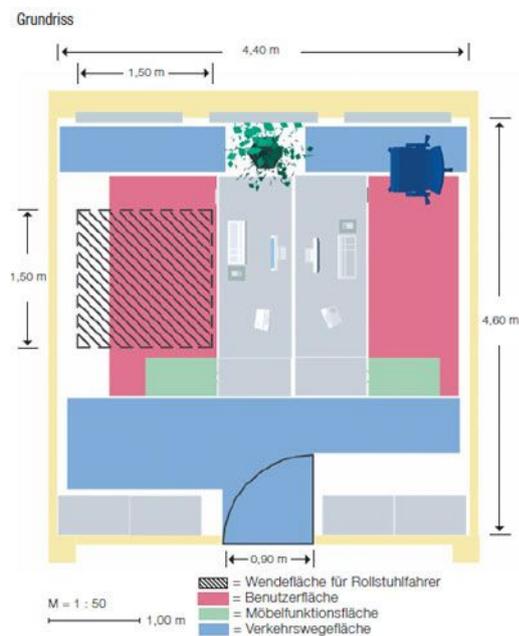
Zweipersonenbüro, barrierefrei – Grundriss
